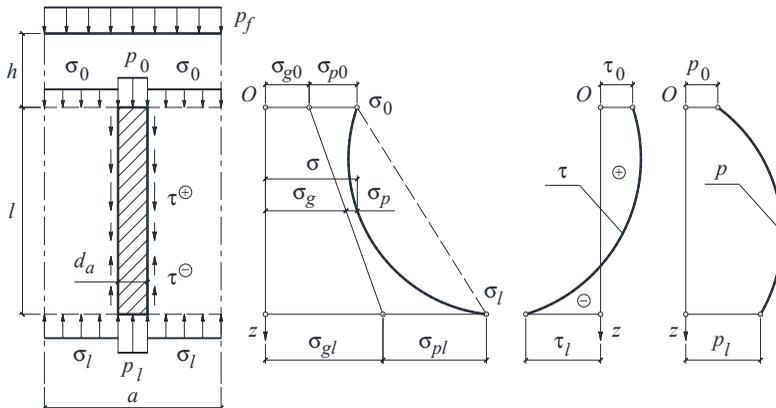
Расчетная схема ячейки армированного поля и эпюры напряжений: σ , σ_p , σ_g – в грунте; t – на контакте «армоэлемент-грунт»; p – в армоэлементе
